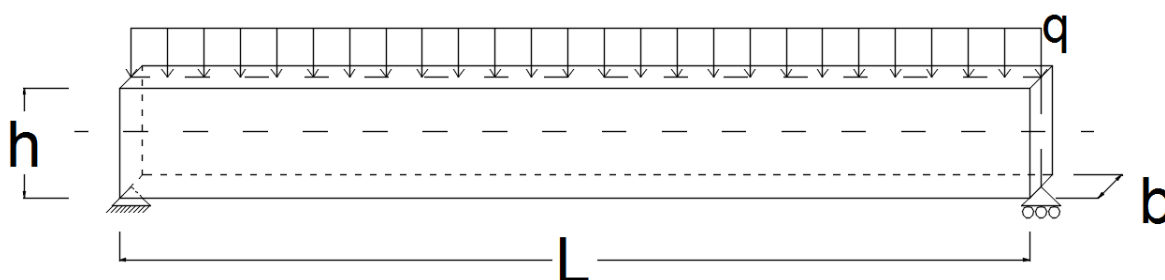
Diagrama de carga de vigas simplemente apoyadas.
